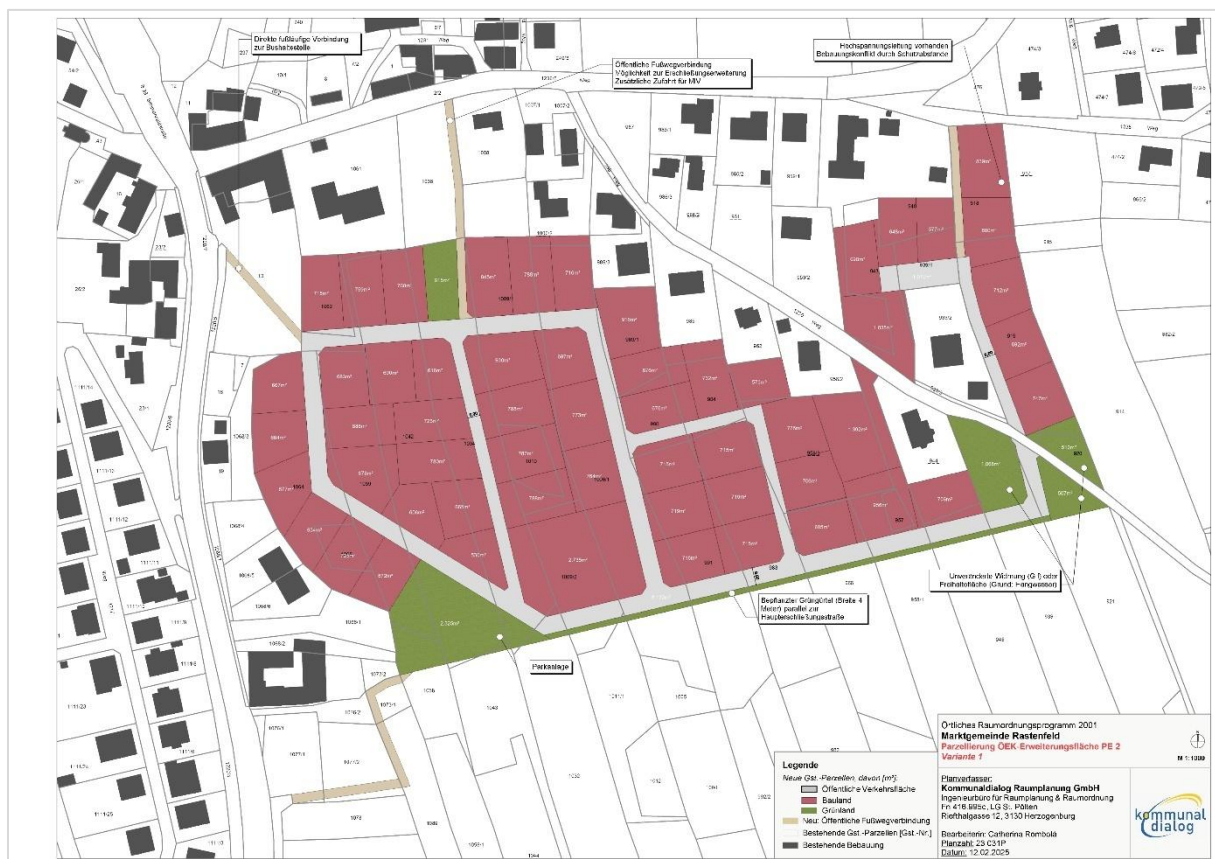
Parzellierung ÖEK-Erweiterungsfläche PE 2/1 und PE 2/2, Variante 1
